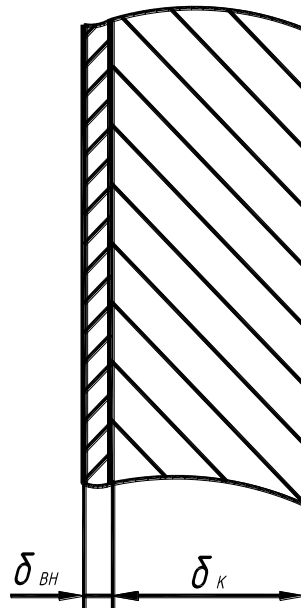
Розрахункова схема зовнішньої стіни будівлі
